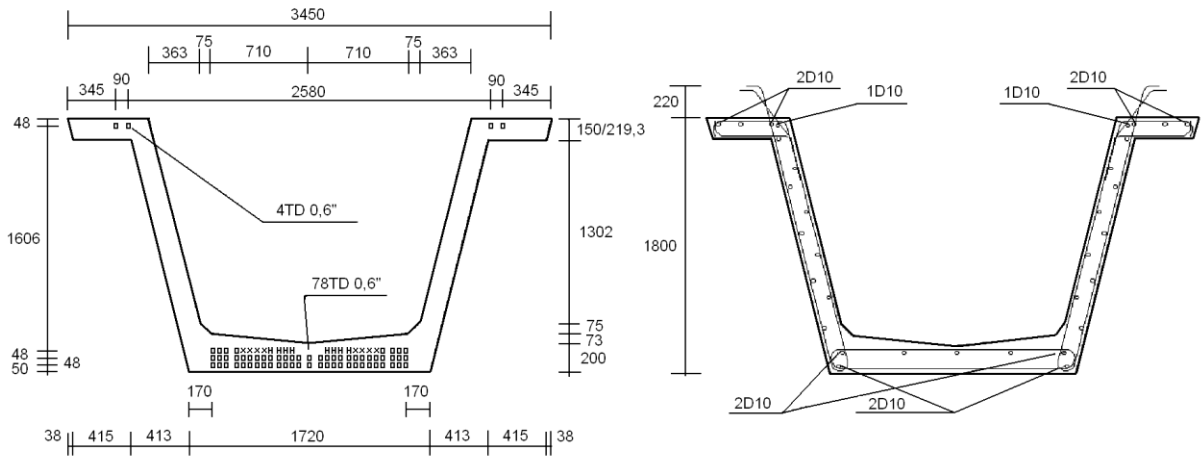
Sección transversal de la viga del viaducto 1 del tramo Muro de Alcoy-Puerto de Albaida
